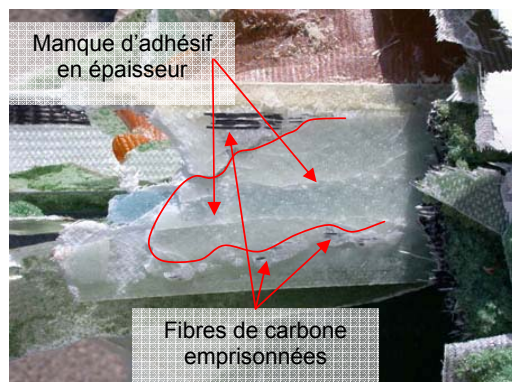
interface de la liaison âme/semelle, manque local d'adhésif en épaisseur
